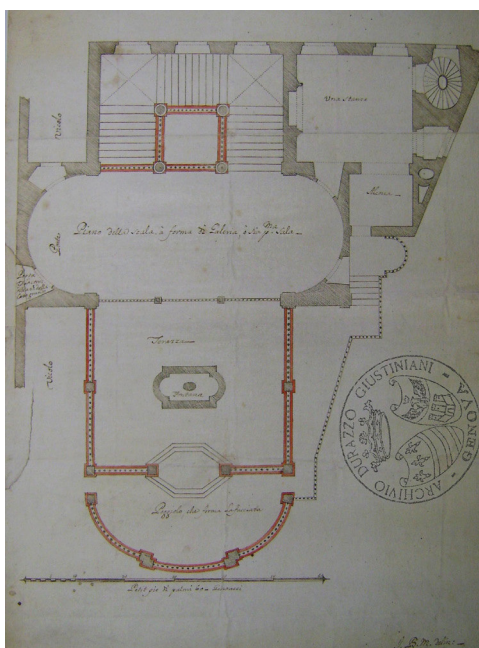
Pianta del piano nobile di un palazzo in centro storico*, Genova (ADGG, Archivio Sauli, fondo disegni, 1837-11)
